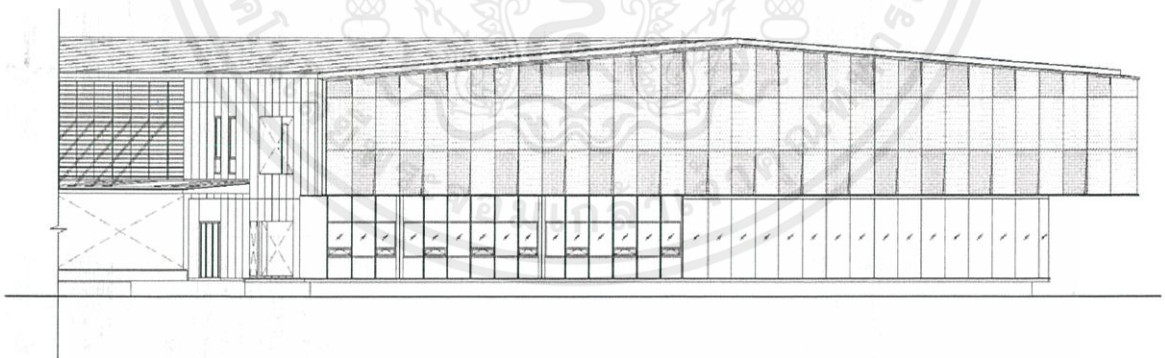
1st Floor TAK Sale Office & Warehouse
